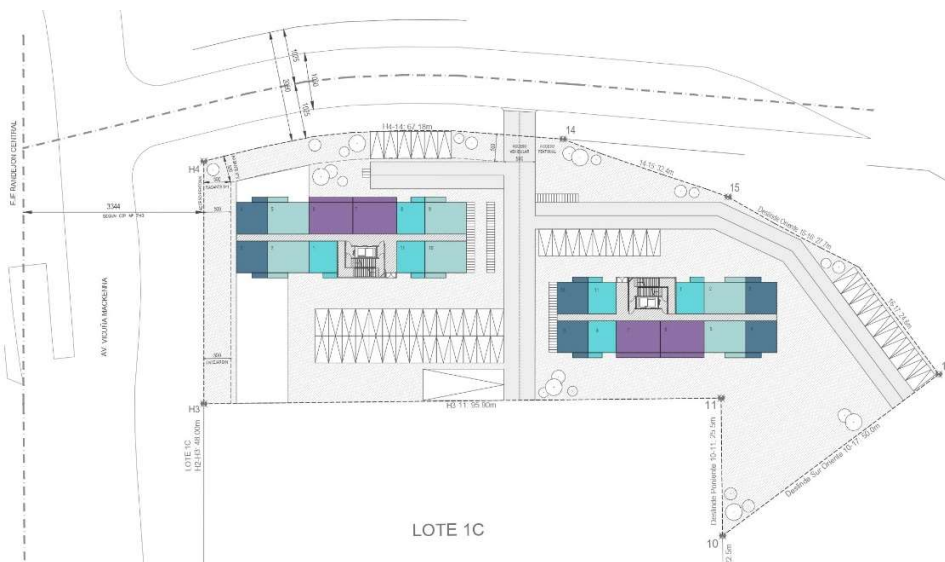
Planta piso tipo (Sin escala). Fuente: Elaboración propia
